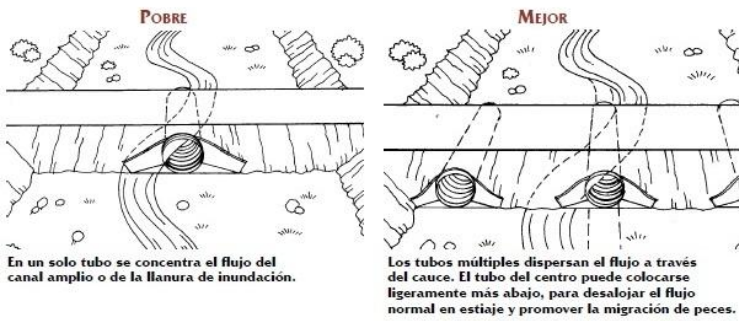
Alineación de la alcantarilla y detalles de instalación.
